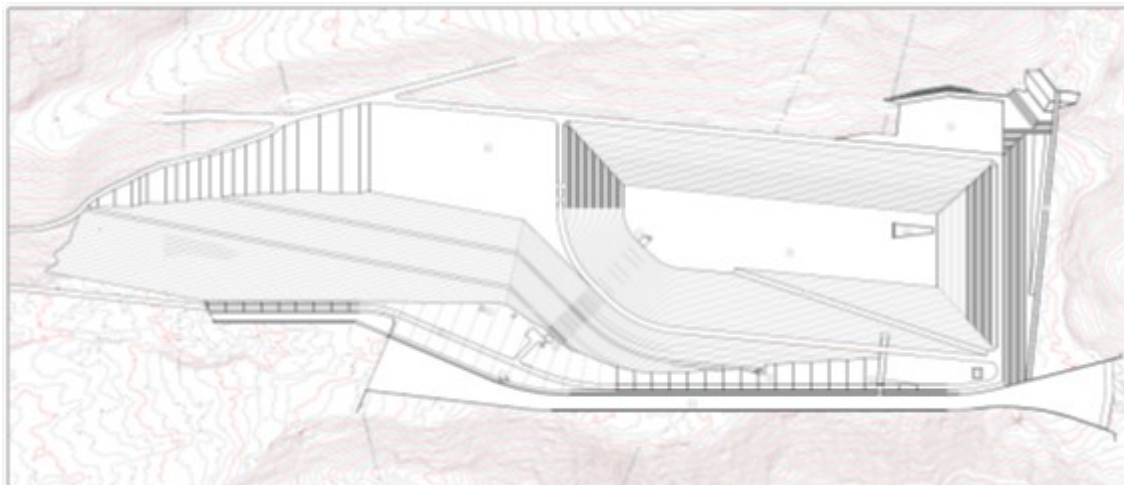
Planimetria Generale del Bacino di Valle (Monte a Dx e Valle a Sx)
